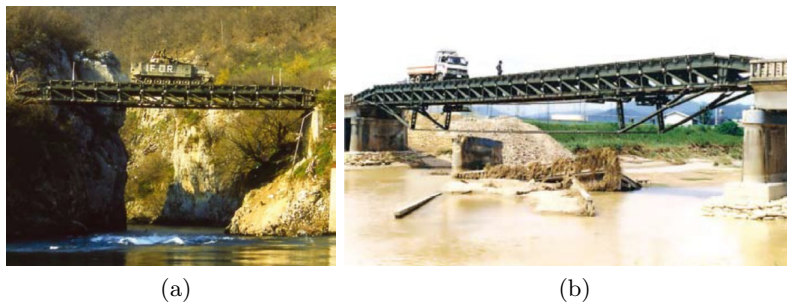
Alternativa de puente Medium Girder Bridge (WFEL)
